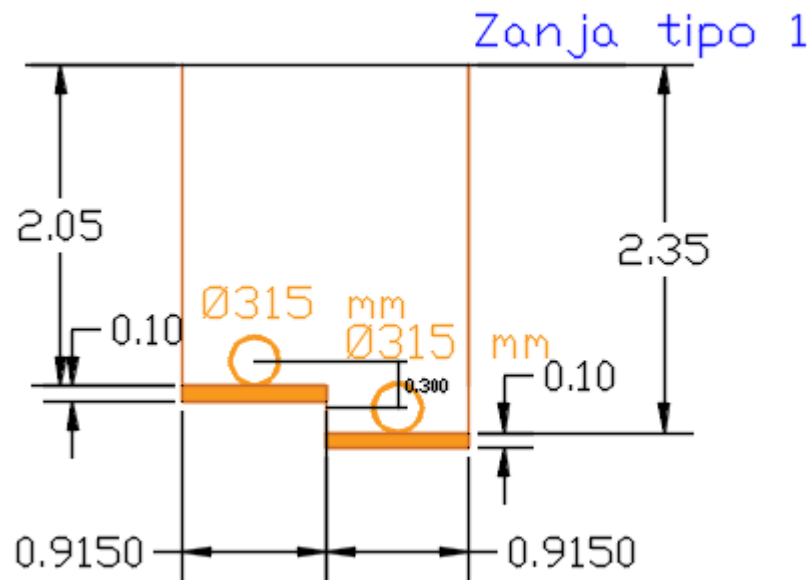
Zanja tipo 1 acotada. Fuente: Autocad.
